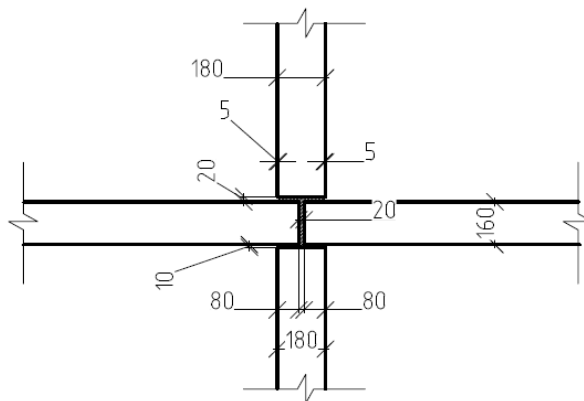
Платформенный стык с двухсторонним опиранием плит перекрытий
